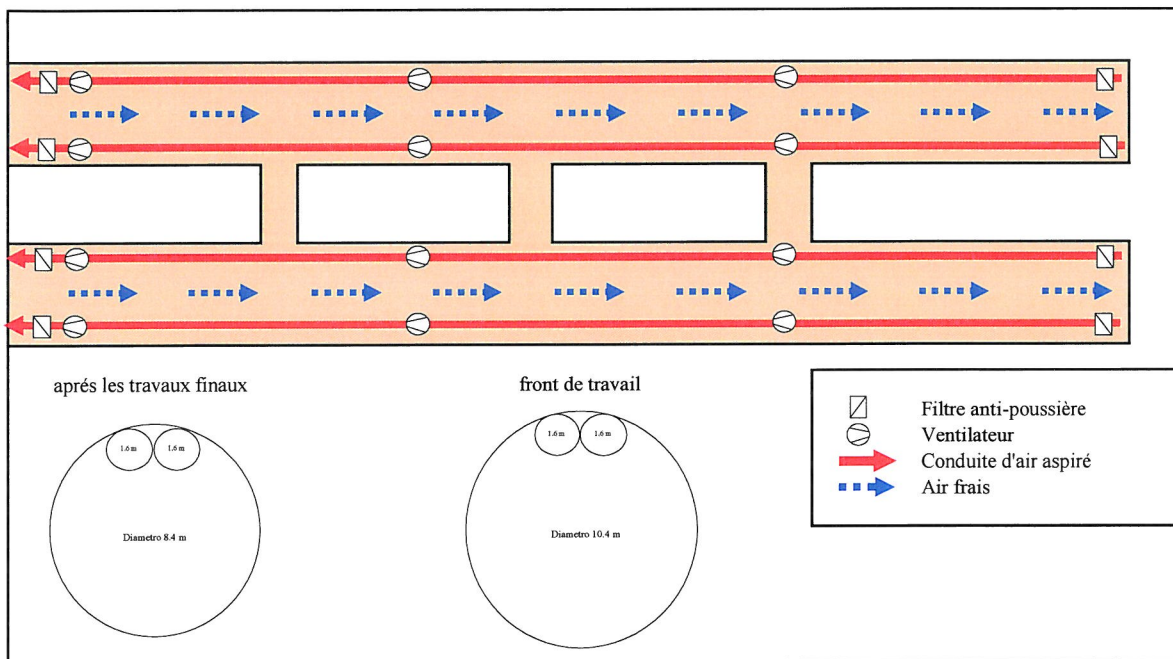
Schema della ventilazione del Tunnel di base scavato dal portale est
